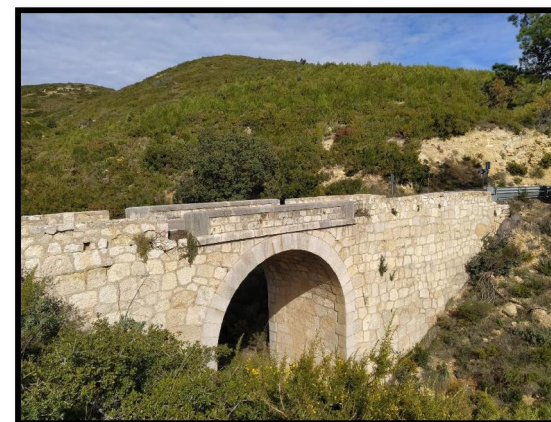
Estructura actual sobre barranco Fuente: Elaboración propia.
